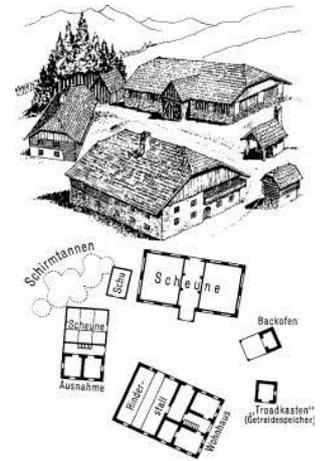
Haufenhof samt Grundriss (austria-forum.org 2016, online)
